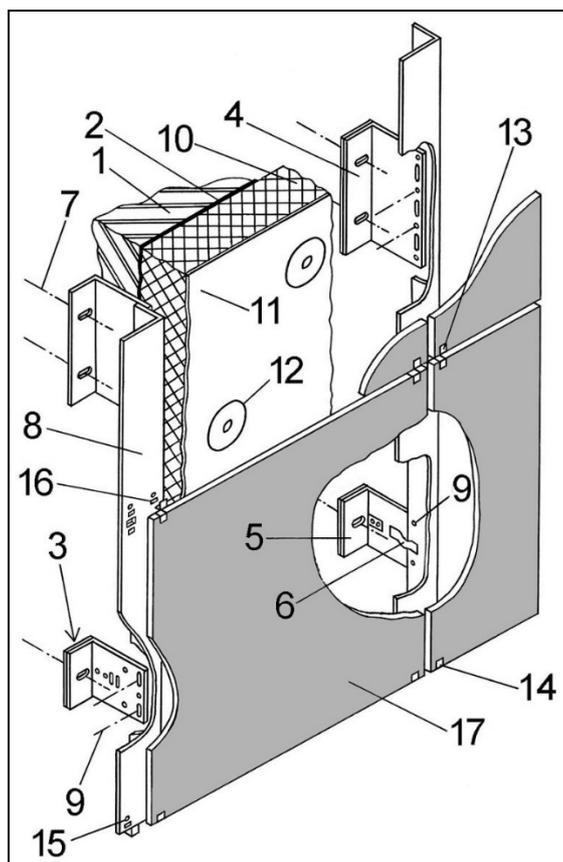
Принципиальное конструктивное решение одного из вариантов навесного вентфасада; 1 – капитальная часть стены; 2 – выравнивающий штукатурный слой; 3 – прокладка; 4 – несущий кронштейн; 5 – опорный кронштейн; 6 – прижимной язычок; 7 – ось дюбель-анкера для крепления кронштейна к капитальной части стены; 8 – вертикальный опорный профиль; 9 – ось заклепки и заклепка; 10 – негорючий эффективный утеплитель; 11 – ветрозащита; 12 – дюбель-анкер; 13 – рядовой кляммер; 14 – концевой кляммер; 15 – заклепка; 16 – уплотняющая прокладка; 17 – облицовочная плита (из керамогранита)
